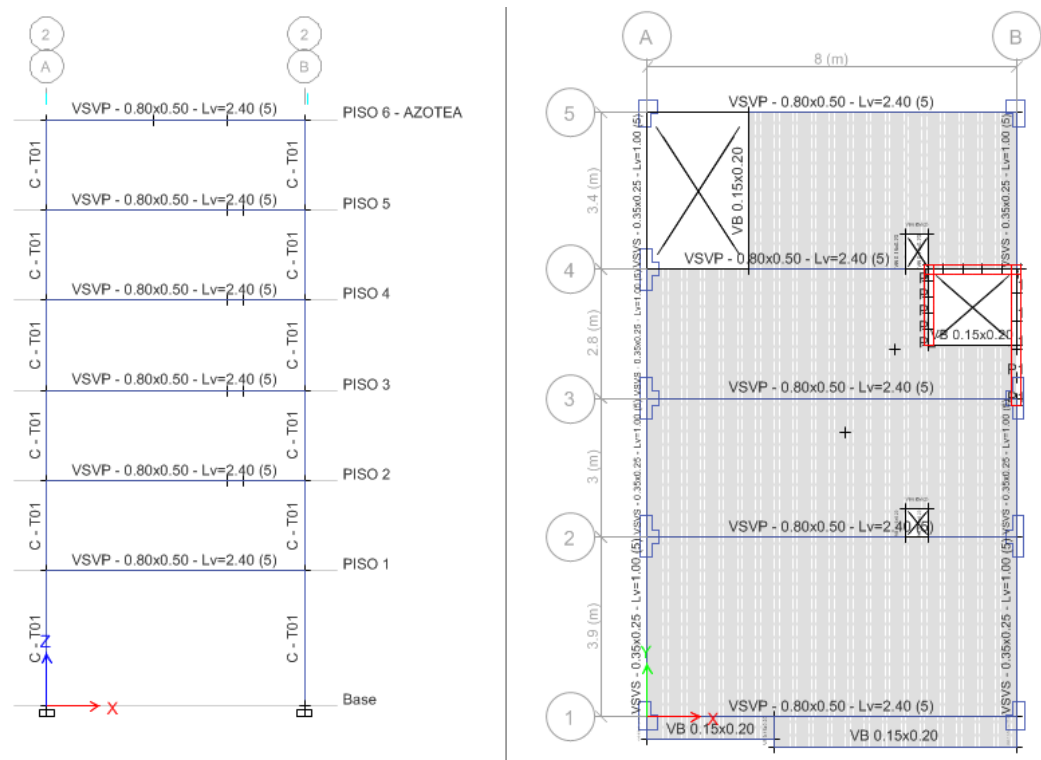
23 Vista en elevación y planta típica de la estructura del pórtico principal 2 - CASO N°05.
